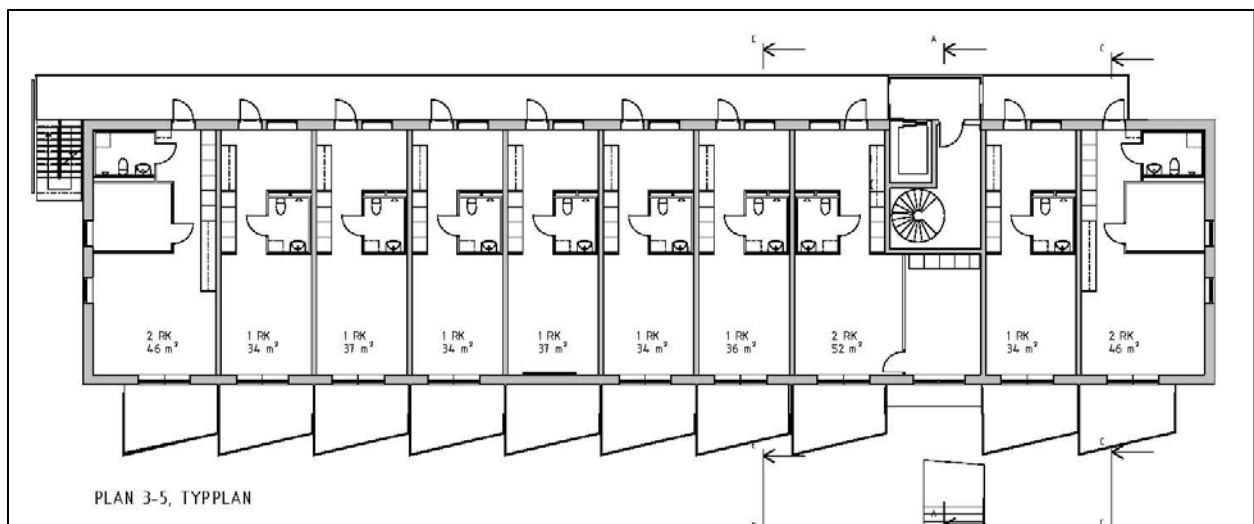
visar planlösning för lamellhusets plan 3 – 5
